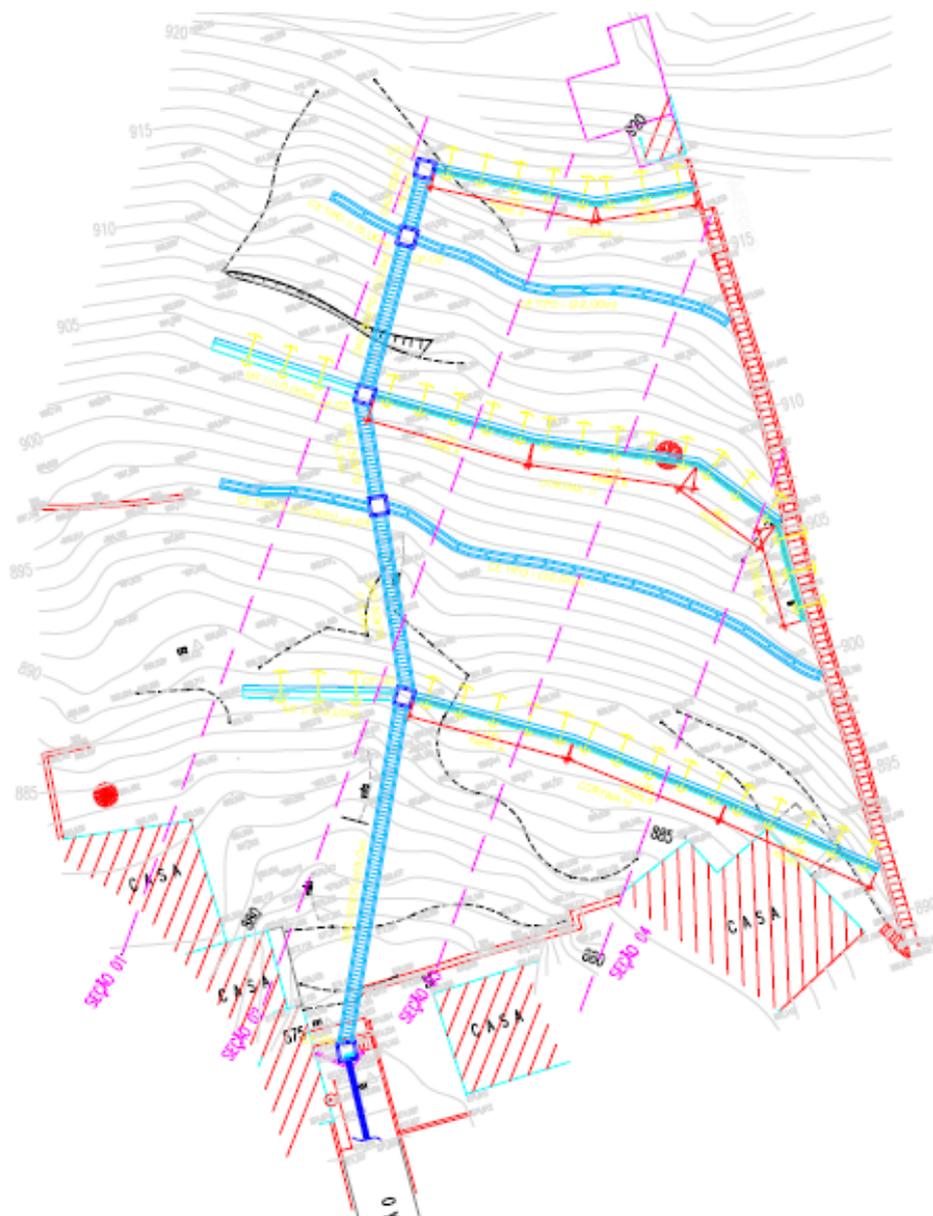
Elementos Estruturais Propostos – Projeto Original [17]
